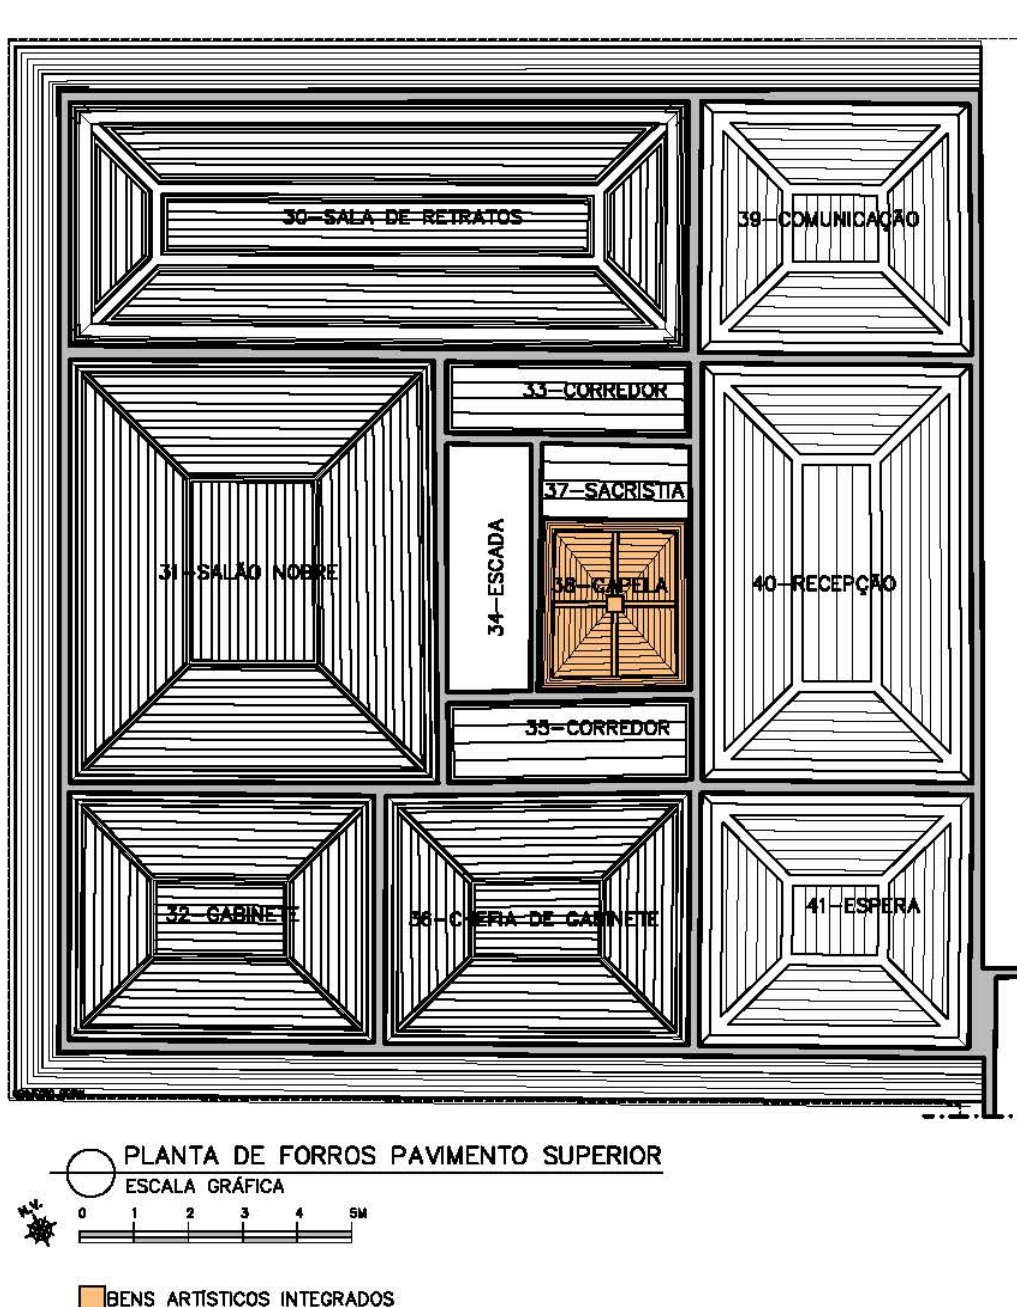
Planta de Forros do Pavimento Superior, com localização dos bens artísticos integrados (Fonte: SANETEC, 2014)
